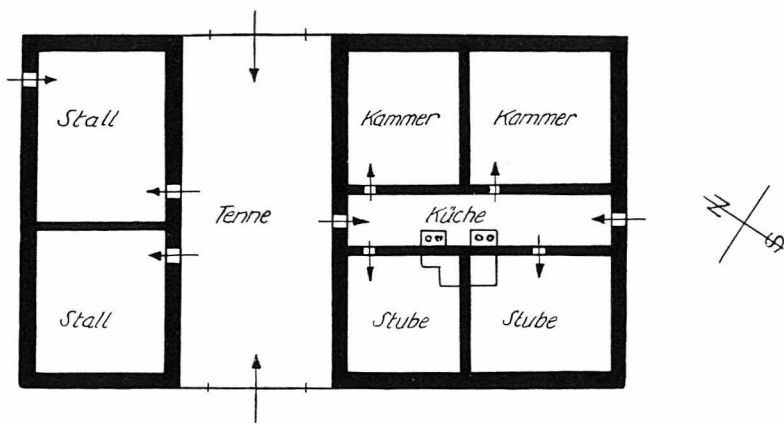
Grundriß eines Aargauer Bauernhauses an der
